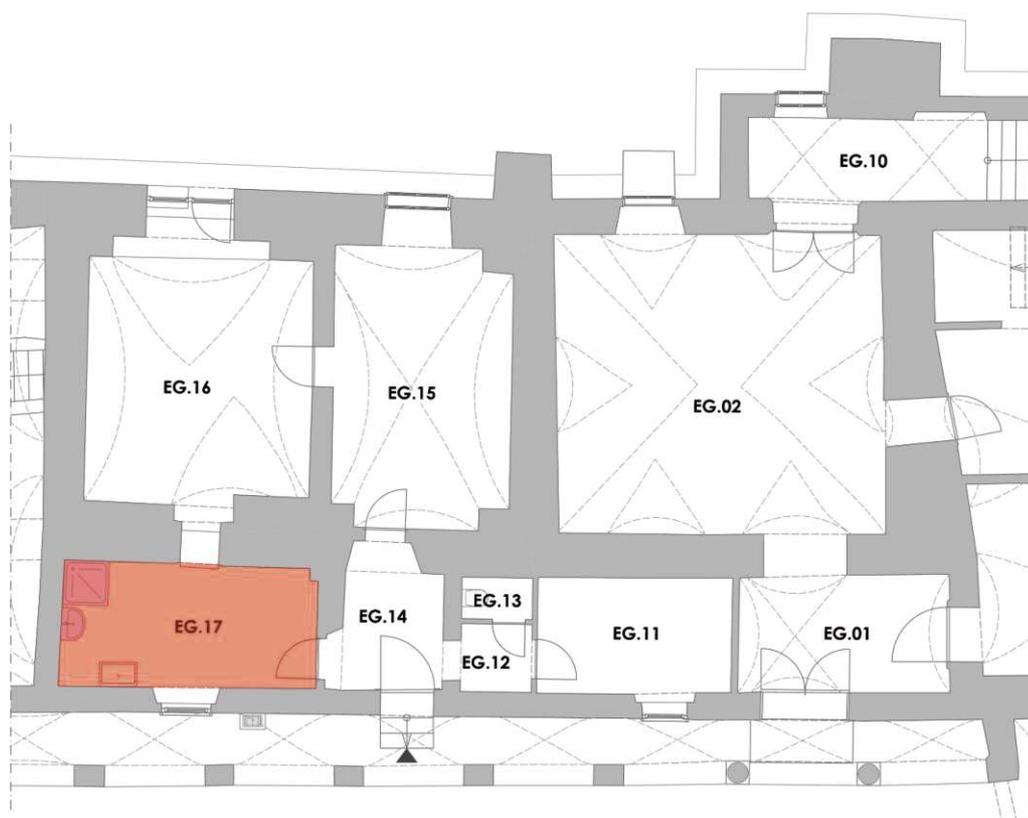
Erdgeschoss Übersichtsplan- EG.17
